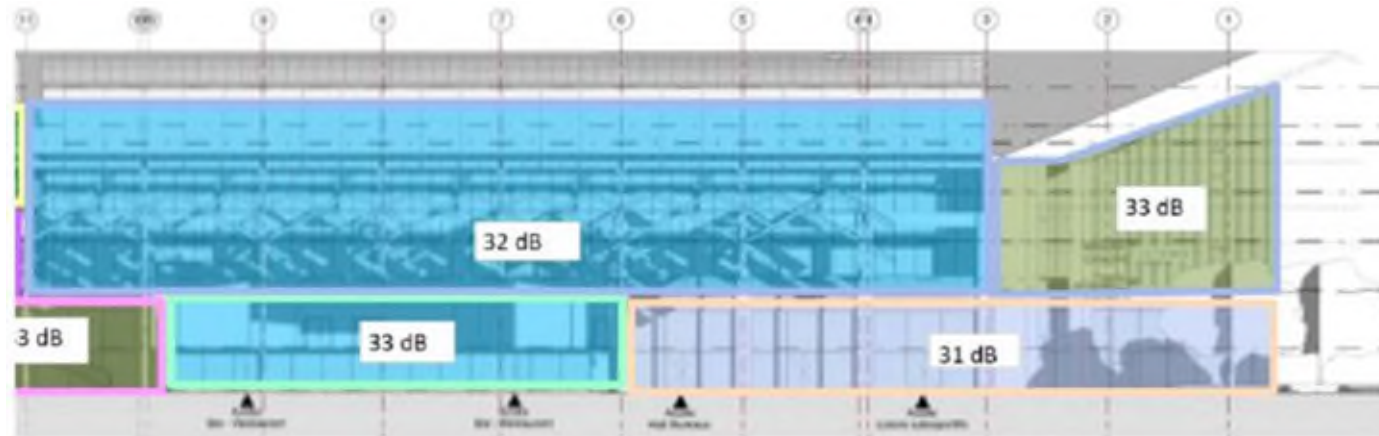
Objectif d'isolement de la façade Sud et façade Est
